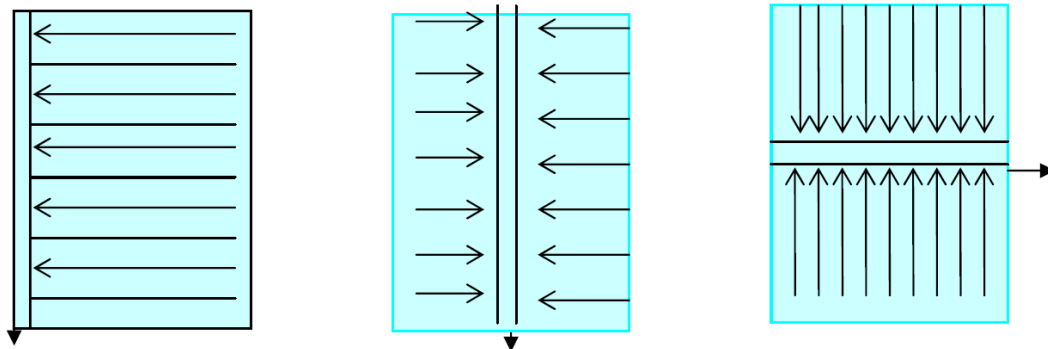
Drenaje tipo paralelo o rejilla. Fuente Documento INDER Medellín. 2001
